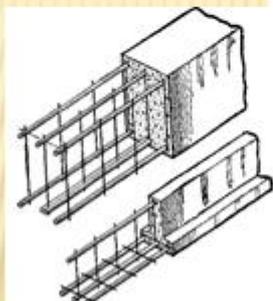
Армирование балок плоскими сварными каркасами
